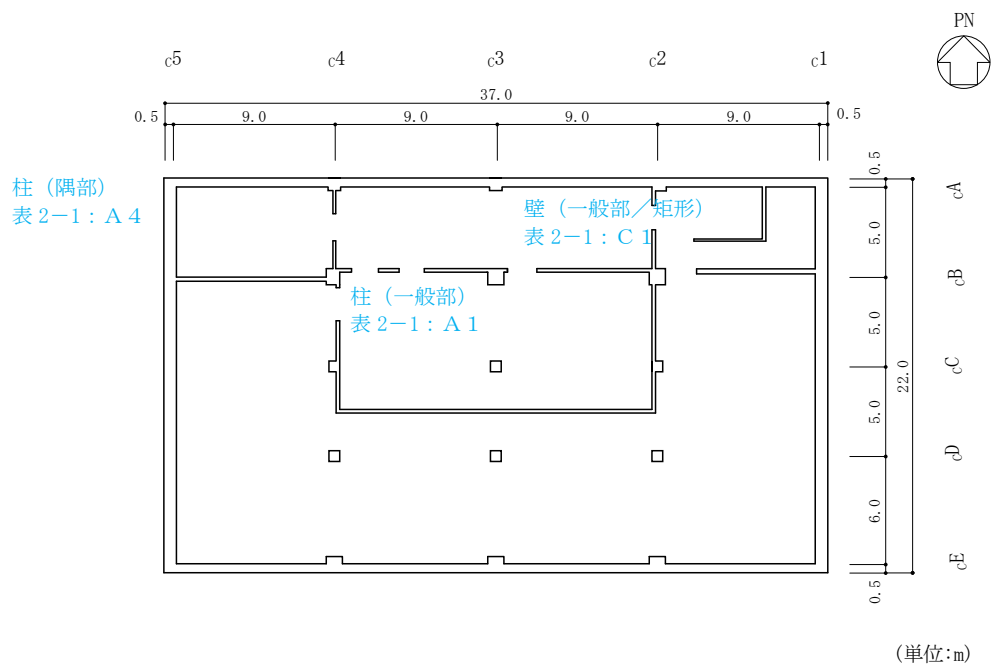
(3) 制御室建物の概略平面図 (EL 12.8m)
